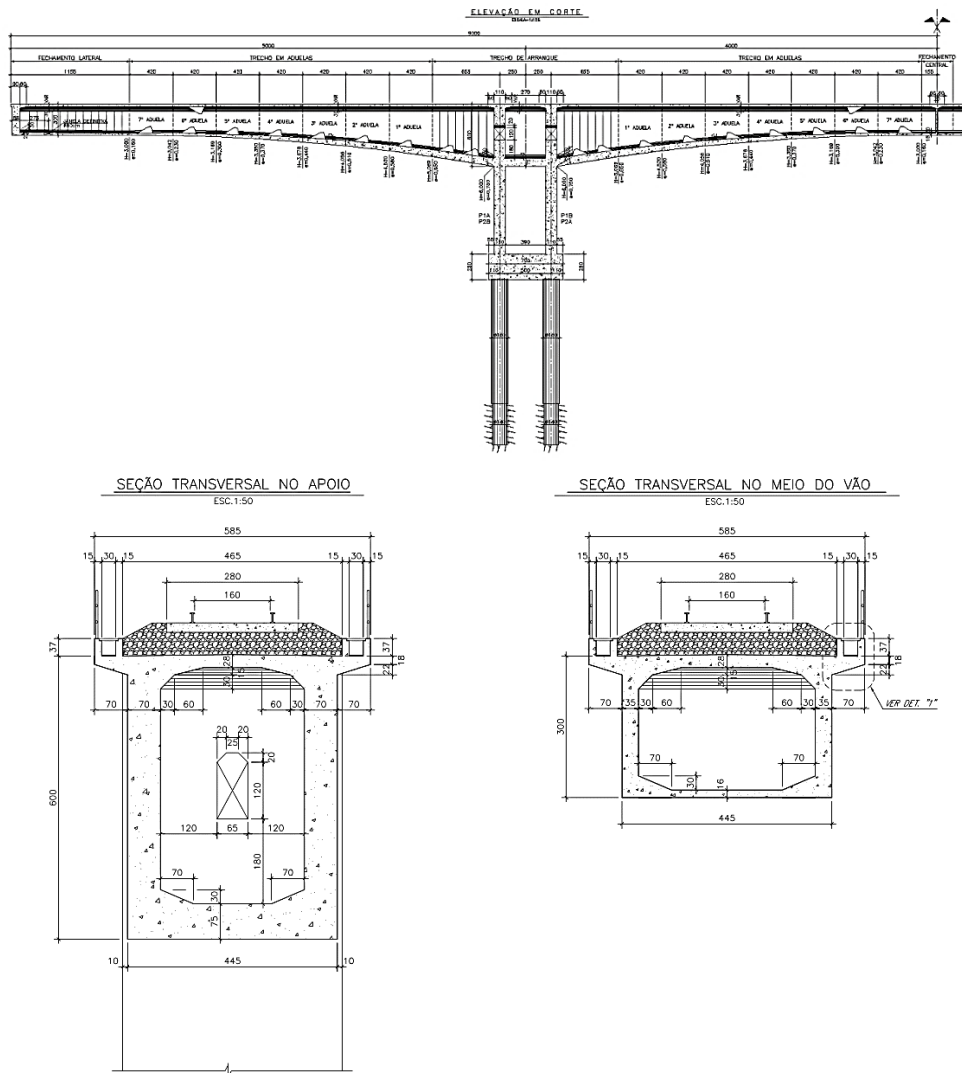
Detalhe do pórtico 65m+130m+65m
